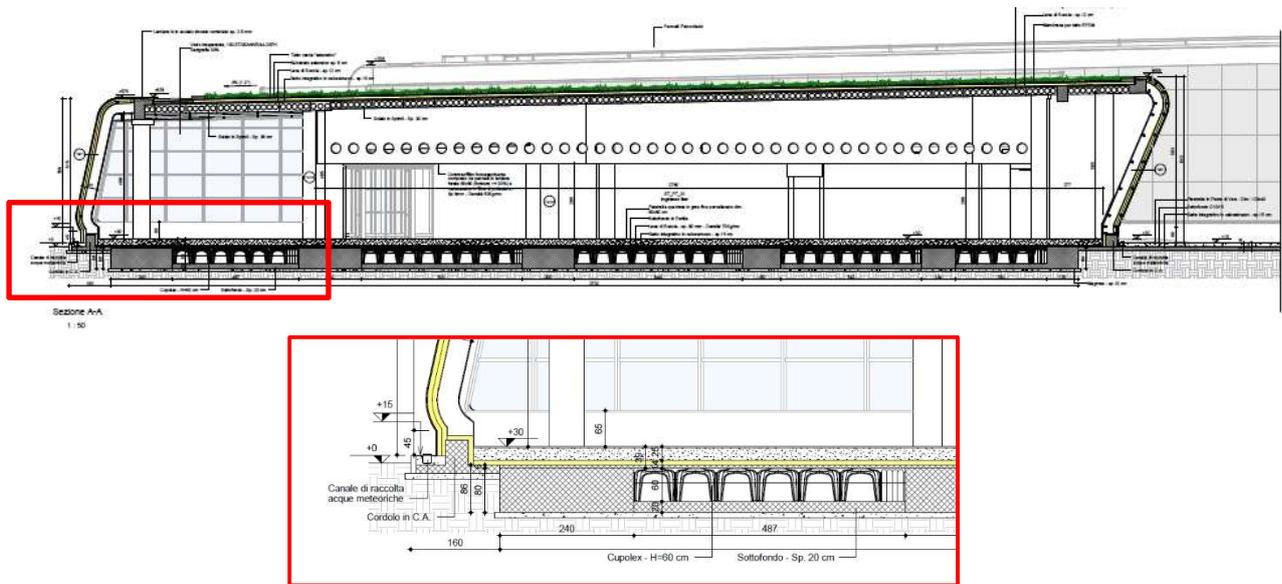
ATC – sezione longitudinale e dettaglio fondamenta
